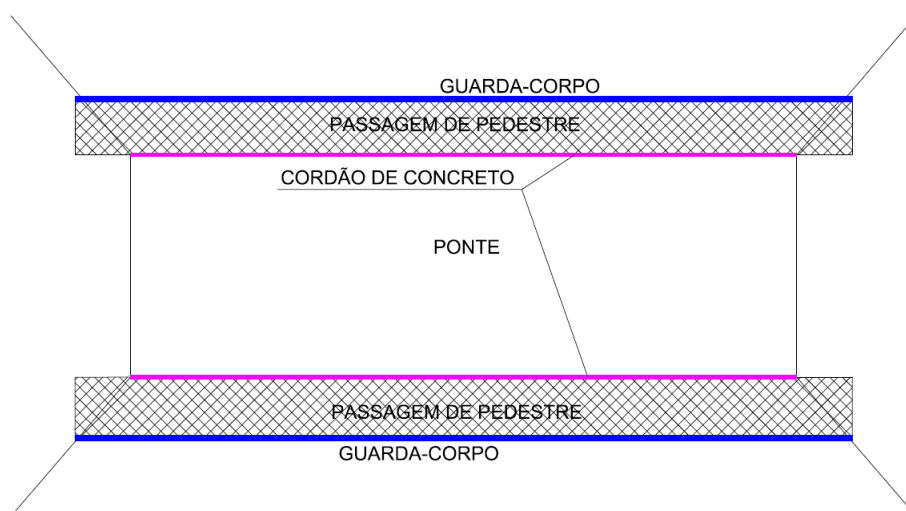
Croqui de implantação de passagem de pedestre (planta)
